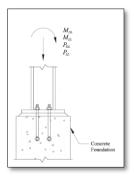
Detalle de Columna que transfiere momentos cortos a la base
